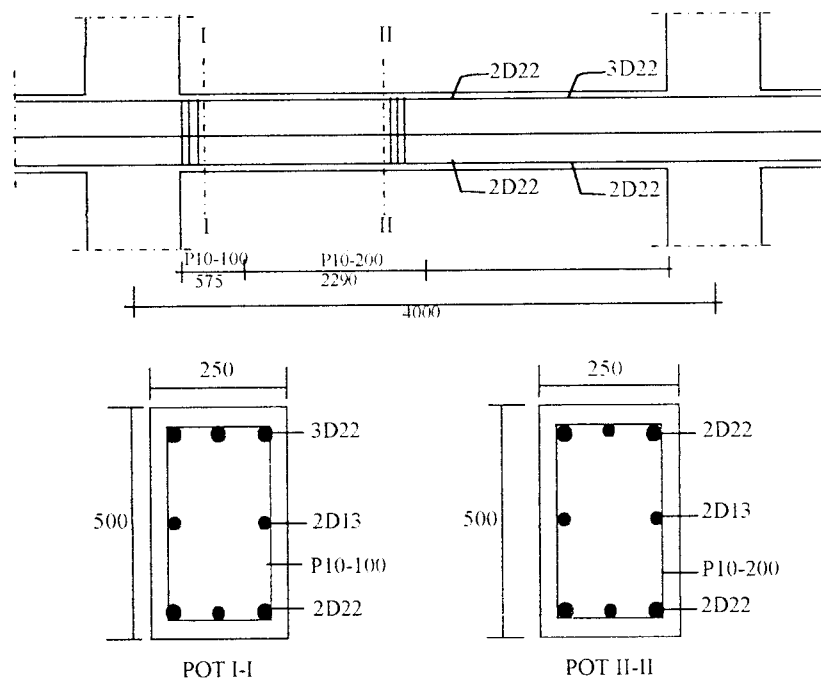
Balok Portal E Bentang 4 m Lantai 7
